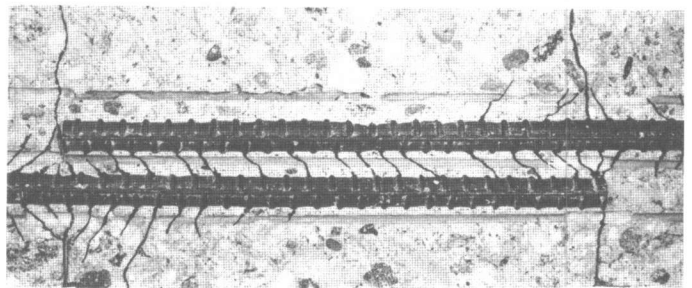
引張異形鉄筋の重ね継手の内部ひびわれ発生状況
